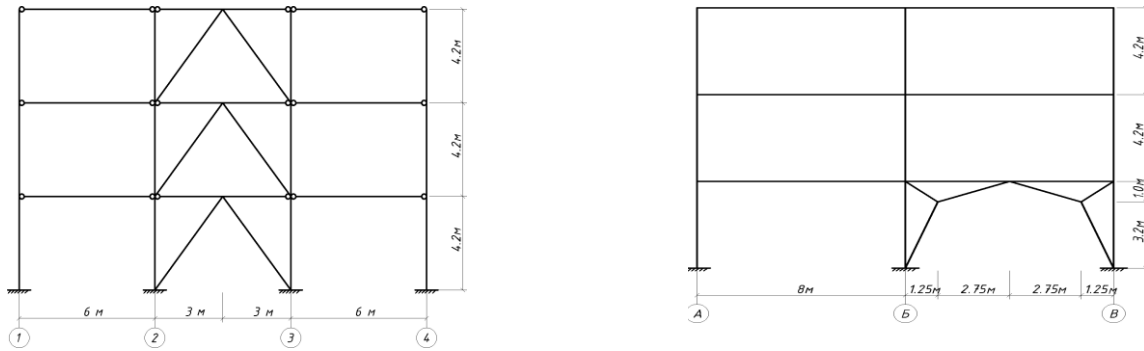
Розрахункова схема поперечника будівлі
